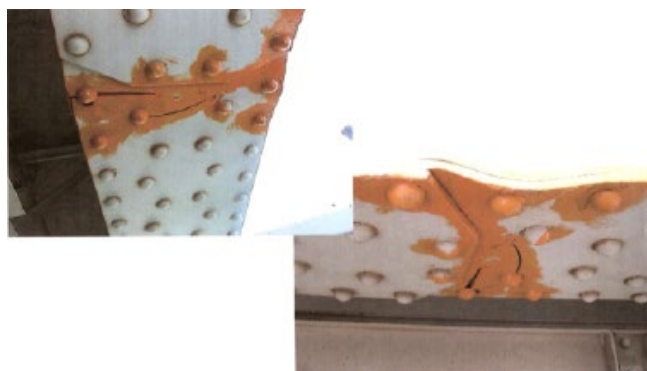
Fissures, amorces de rupture, suite à un choc de bateau sur acier fragile d'une membrure inférieure de pont (photo CETE Méditerranée).
